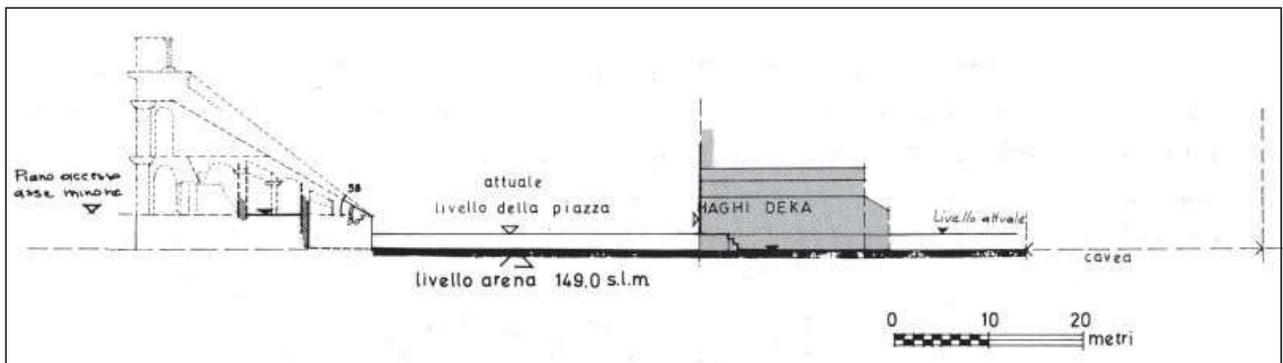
Gortina, anfiteatro. Sezione sull'asse minore con ipotesi di restituzione dell'alzato e posizione della chiesa dei Sani Dieci nell'arena (arch. M. Ricciardi).
